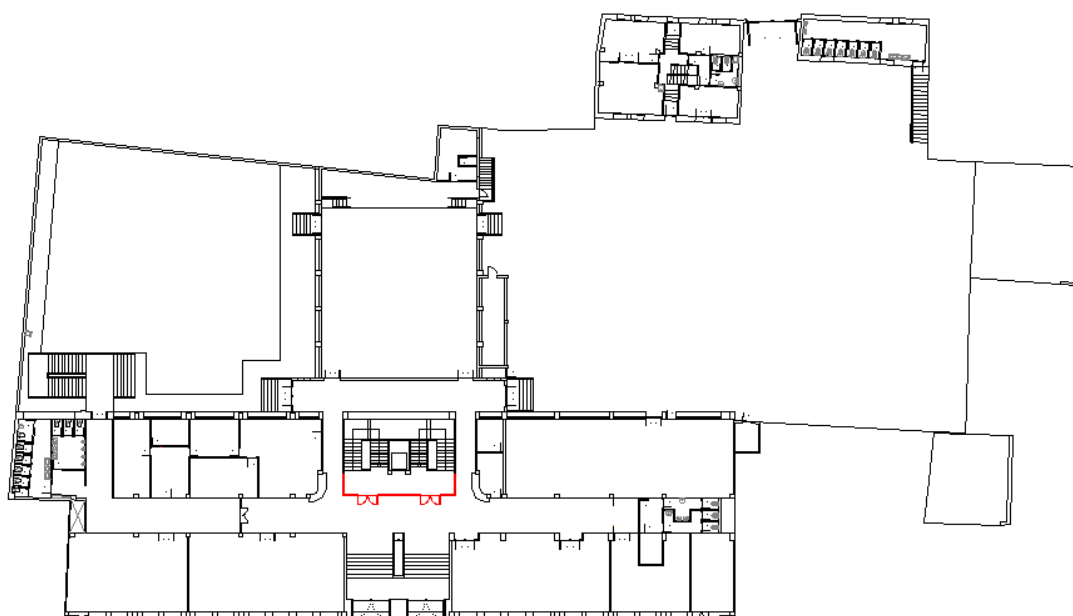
Compartimentación escalera protegida en planta baja. Fuente: Elaboración propia.
